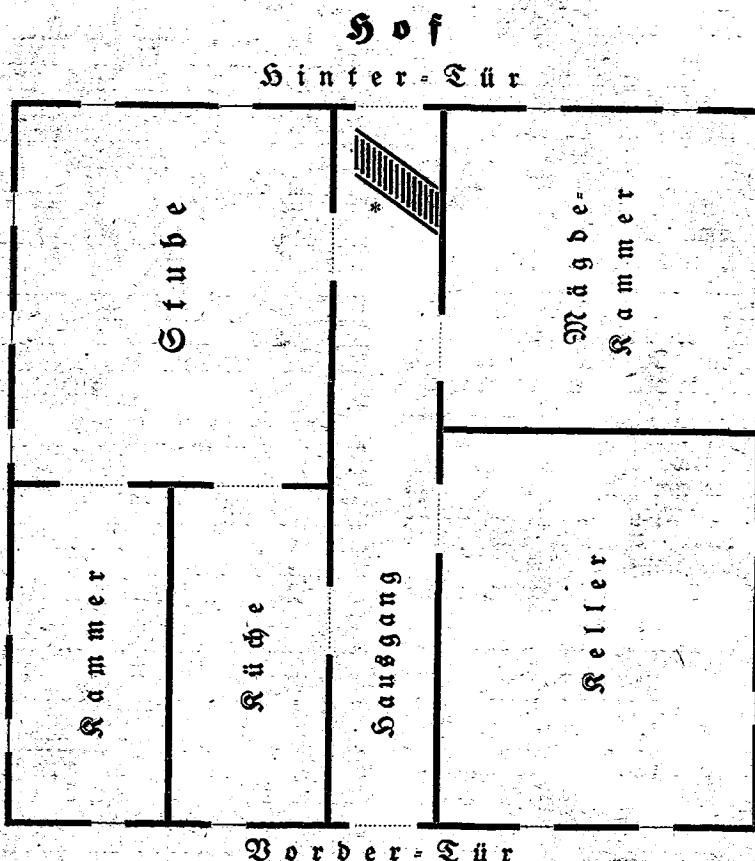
Grundriss des Wohnhauses eines alten Bauerngehöftes im unteren Mühlviertel.
